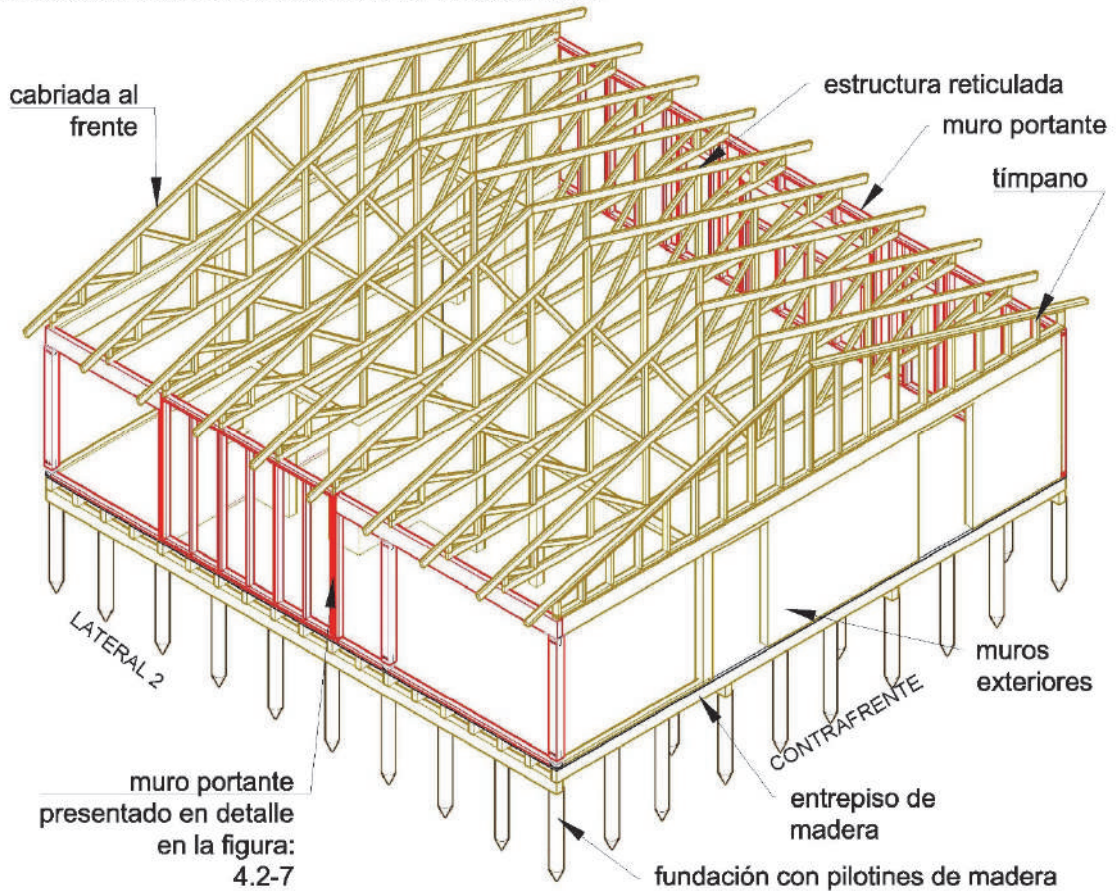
Distribución de los componentes estructurales de la cubierta
